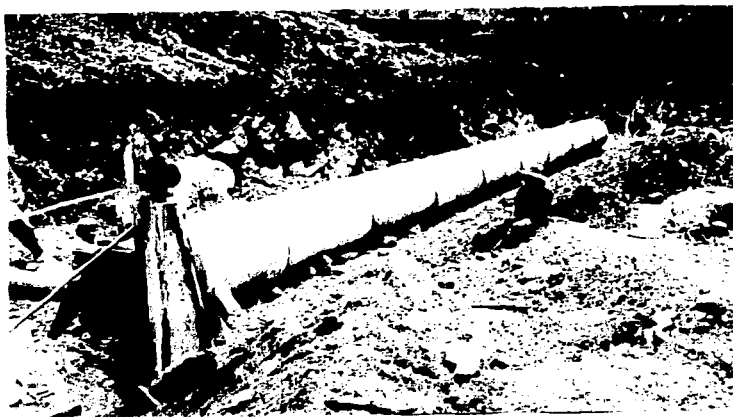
Colocación de T.C..0.90 m. Ø y cimbrado para muro de cabeza
